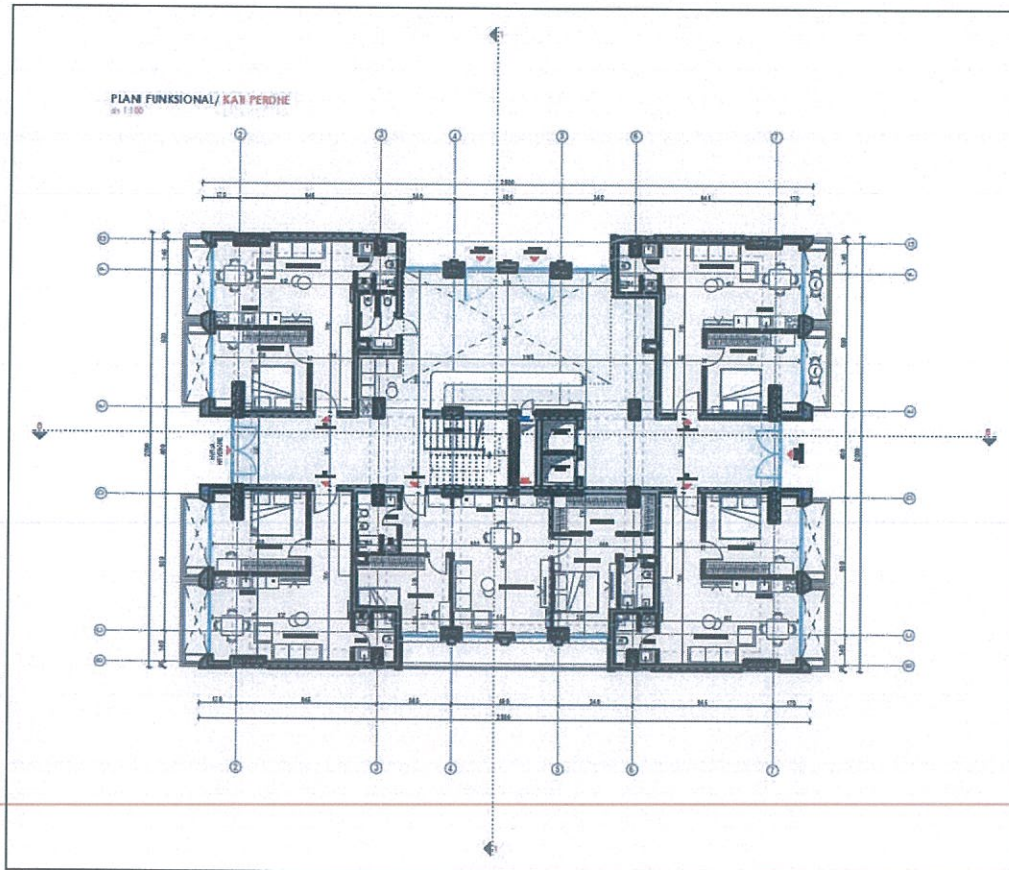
Planimetria e katit përdhe dhe katit të parë
